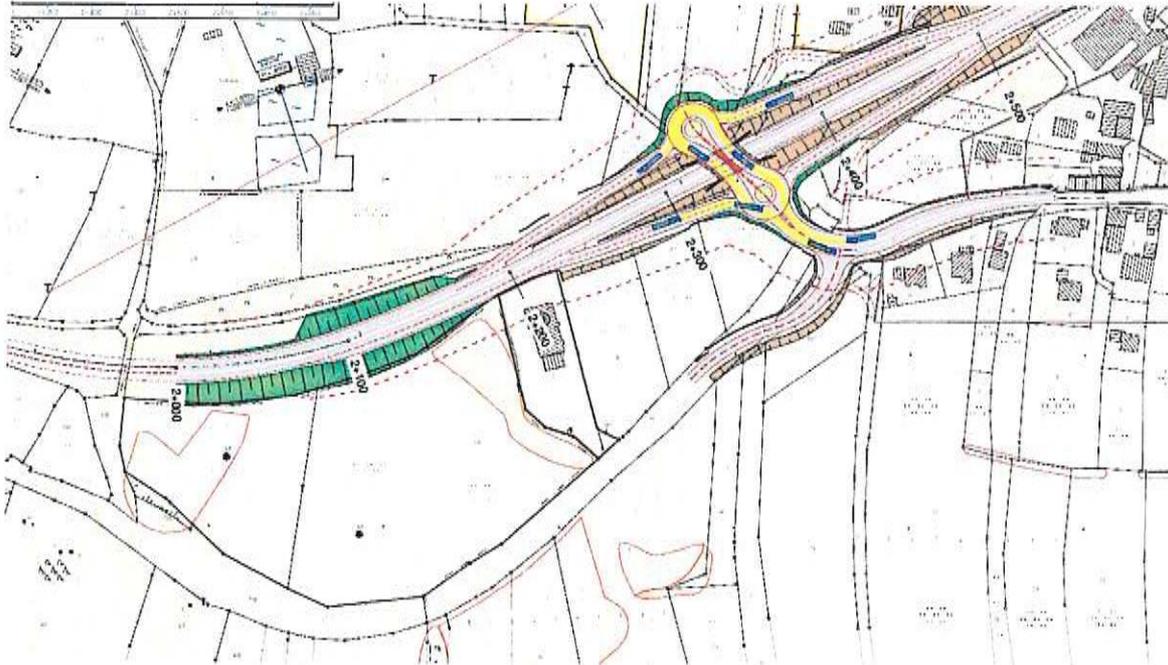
Darstellung der Variante 6.3 im Lageplan
